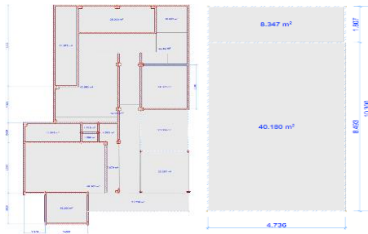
and 23 Senja Coffee and Memories Godean Floor Plan
